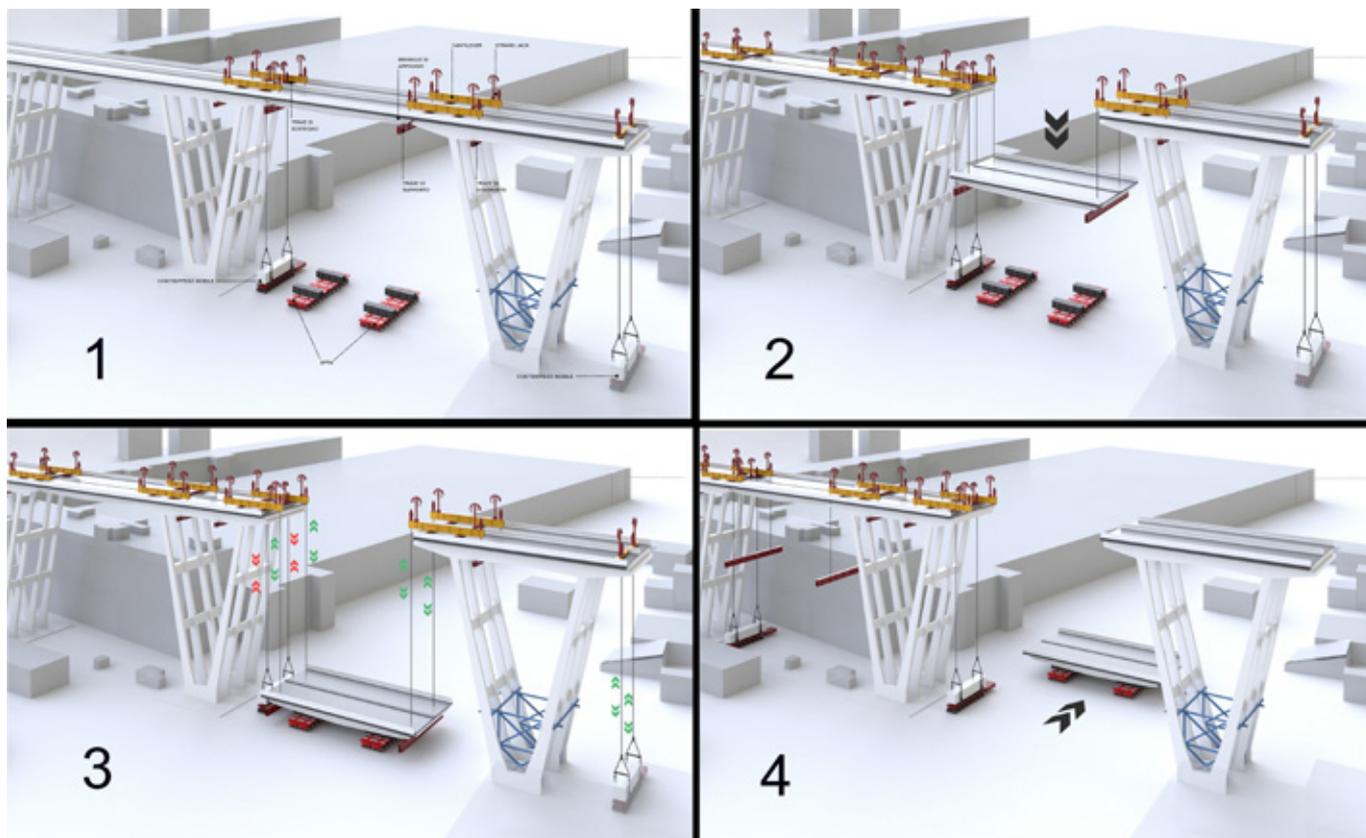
Abbassamento della trave tampone 7 con il “Fagioli cantilever beam system”
